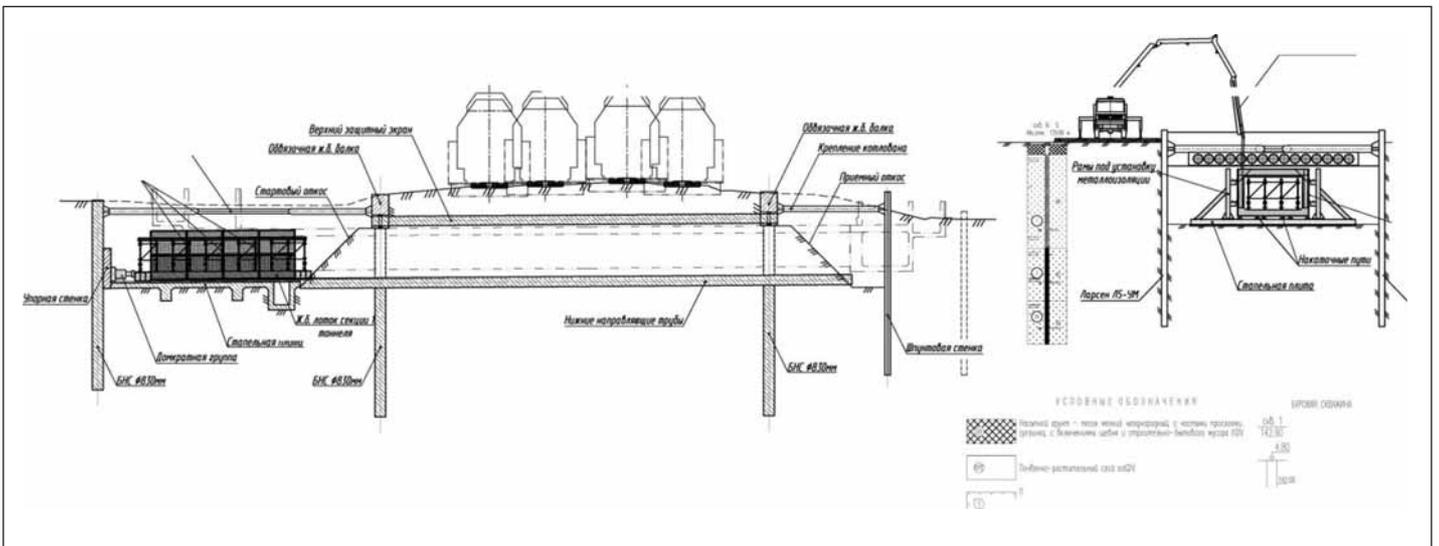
Бетонирование на стапеле стен и перекрытия железобетонной секции
